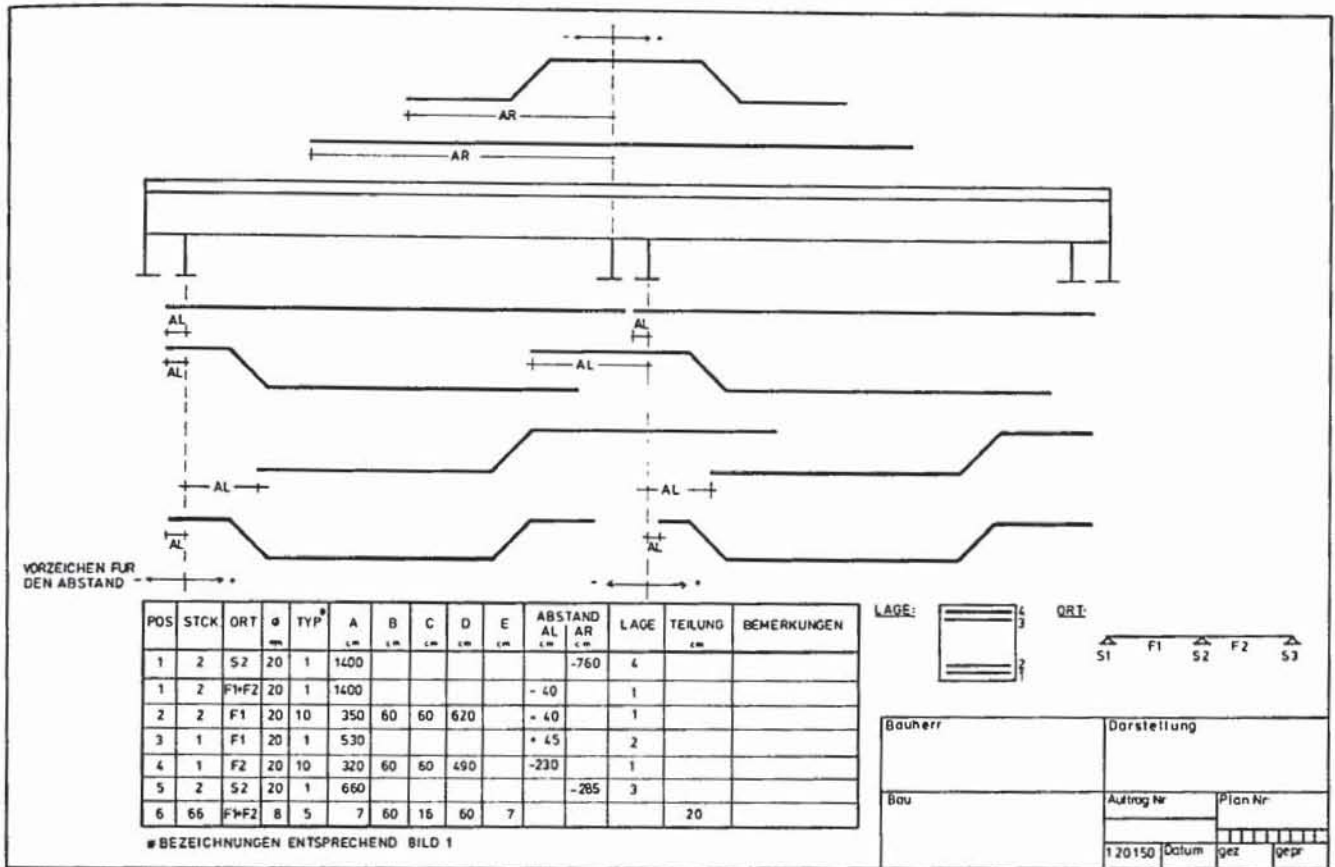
Systembewehrungsplan für einen Zweifeldträger mit herkömmlicher Bewehrung
